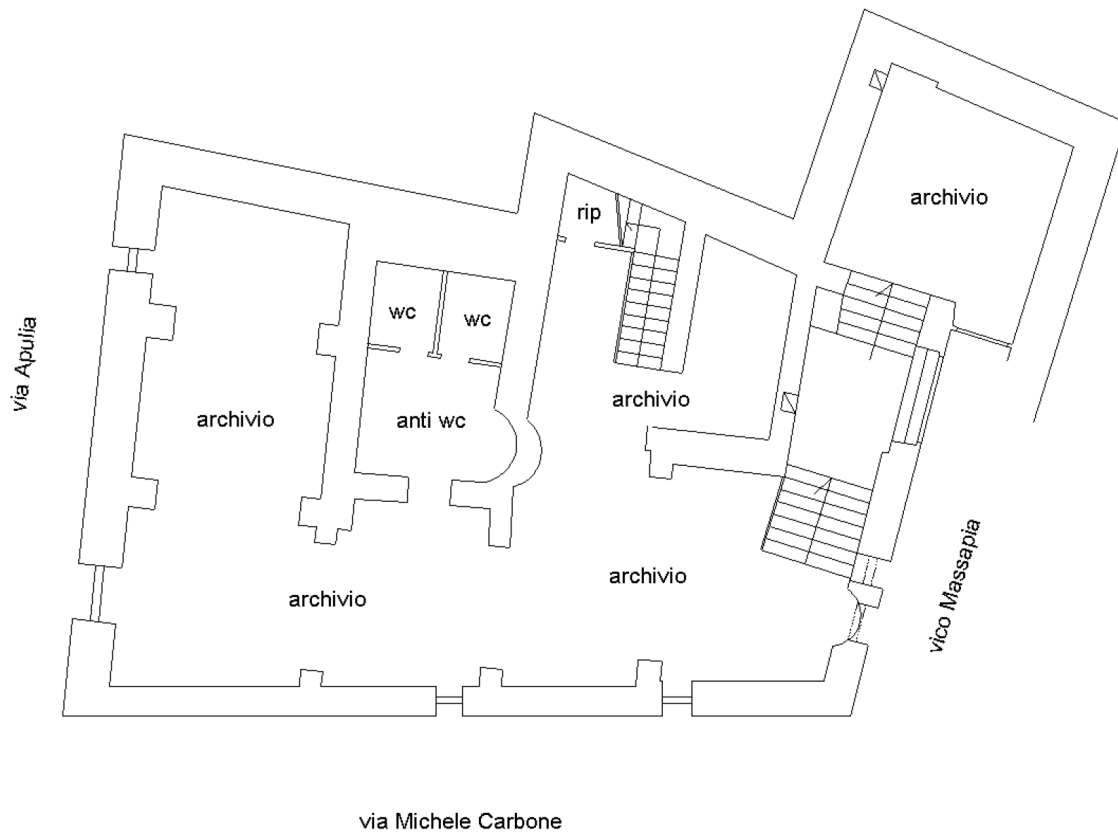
Planimetria catastale sub 11. Piano seminterrato
